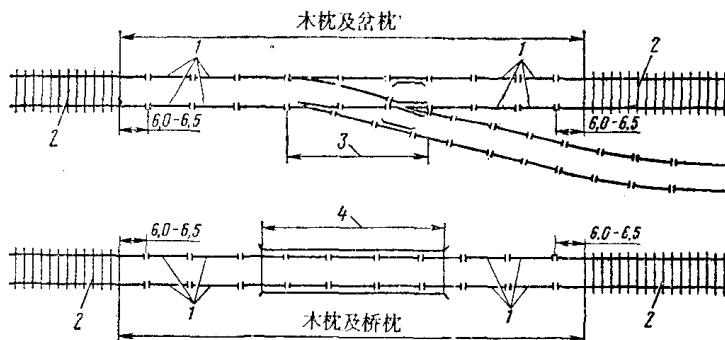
钢筋混凝土轨枕无缝线路与道口及铺木枕的桥衔接图
